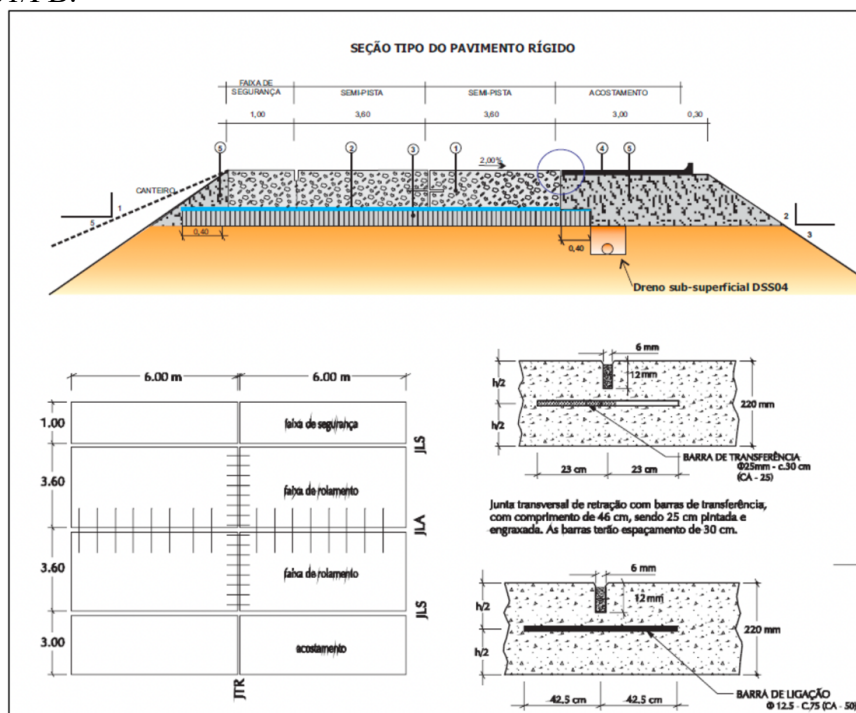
Seção tipo do pavimento da BR-101/PB (ARAÚJO JÚNIOR 2022).
